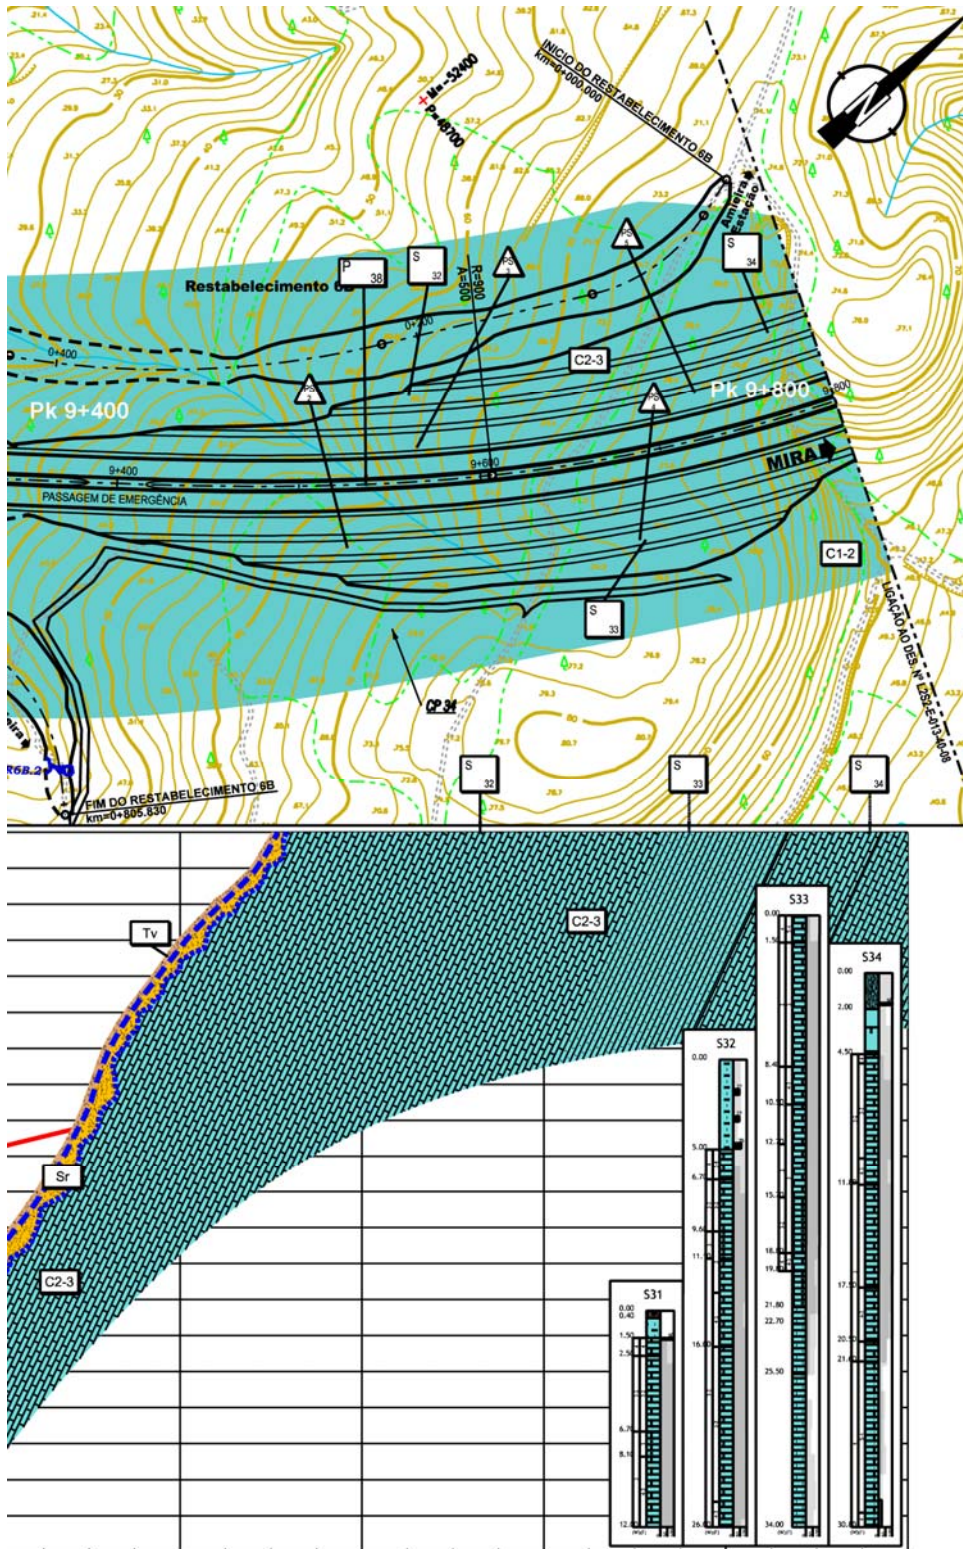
Planta de localização: pontos topográficos e perfil geotécnico da obra (Luis et al., 2006).
